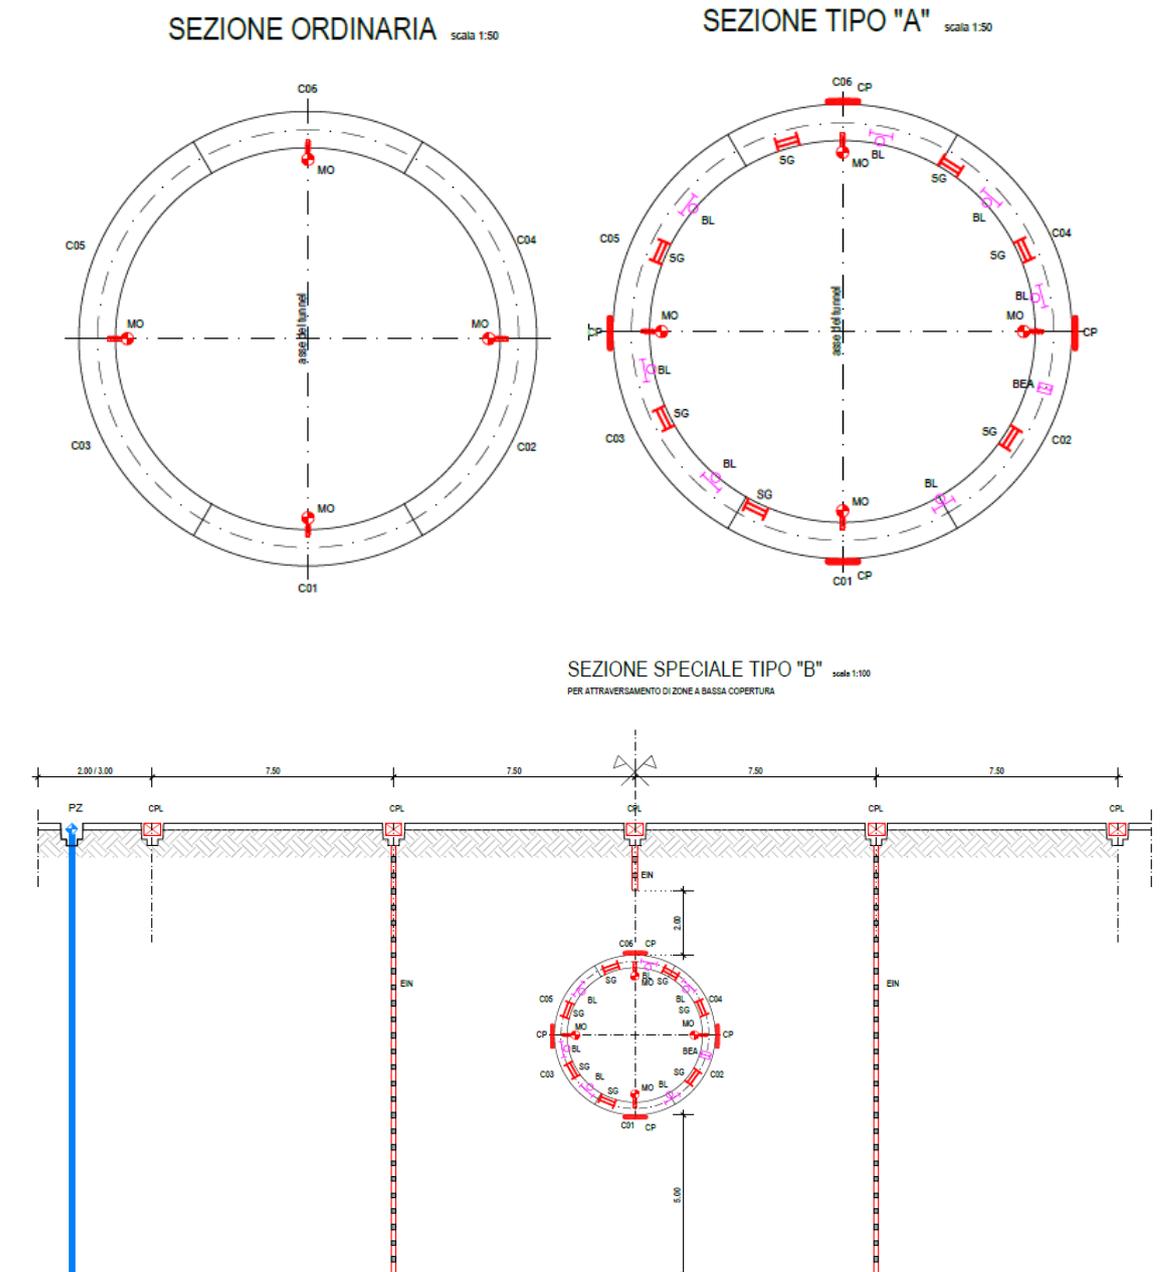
Sezioni strumentate della galleria di derivazione
